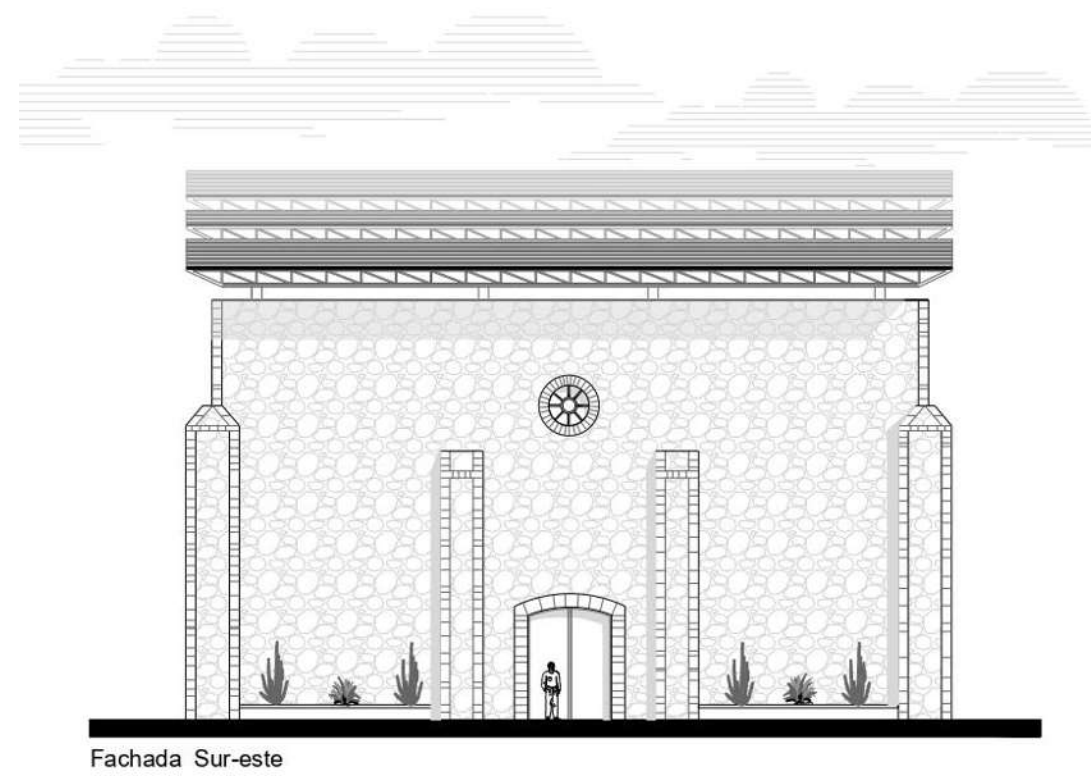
Plano arquitectónico 4. Fuente: Elaboración propia.
